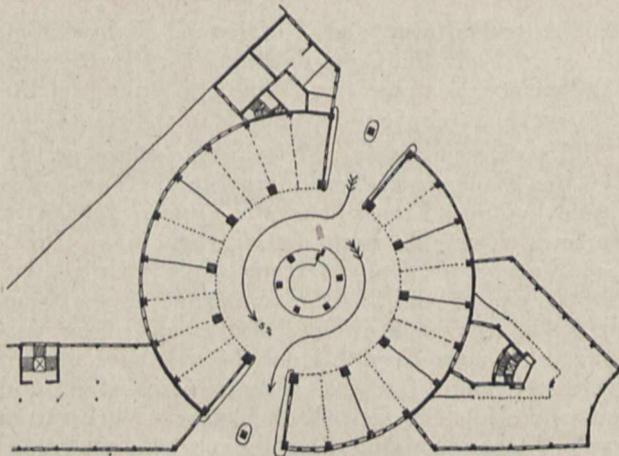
Grundriß einer Hochgarage auf einem Eckgrundstück mit trichterförmigem Lichthof und schraubenförmiger Fahrstr. Entwurf Architekt Müller.
